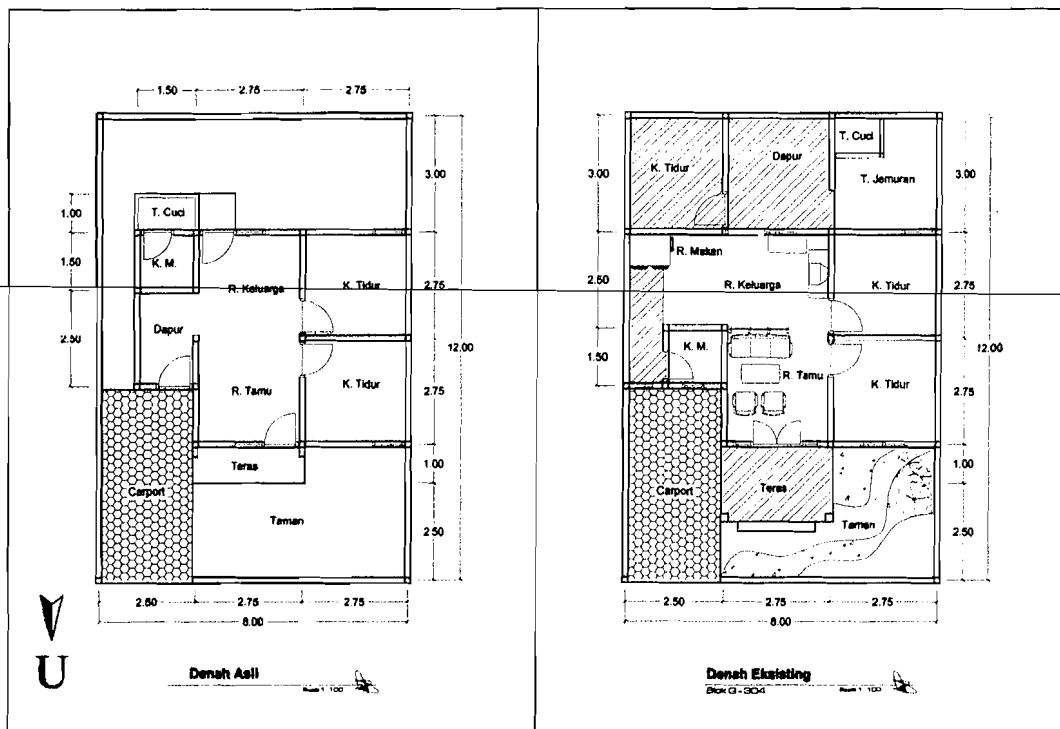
Denah Asli dan Denah Eksisting Blok C 355 yang mengalami perluasan kearah belakang dan penambahan tempat jemuran di lantai dua serta penambahan luas teras.
